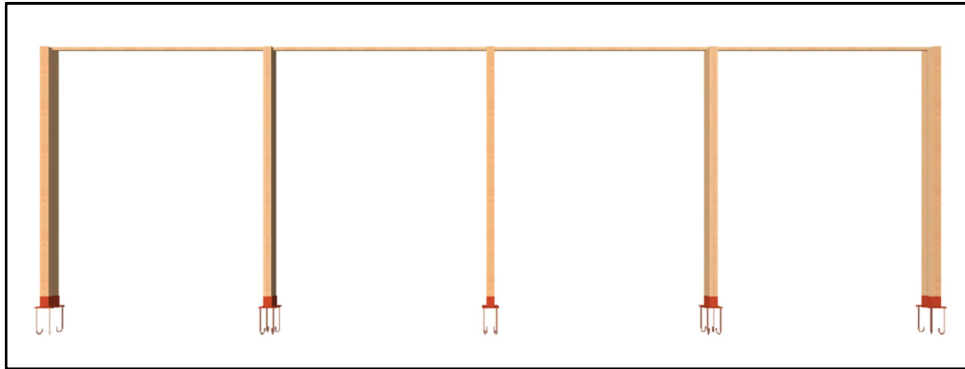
CSA Fachada. Fuente: CYPE 3D.
